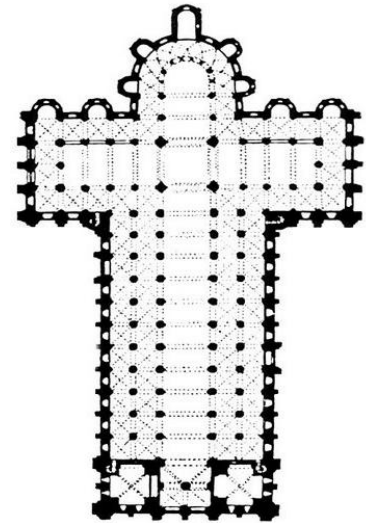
Basilica Saint-Sernin de Toulouse, Planta
